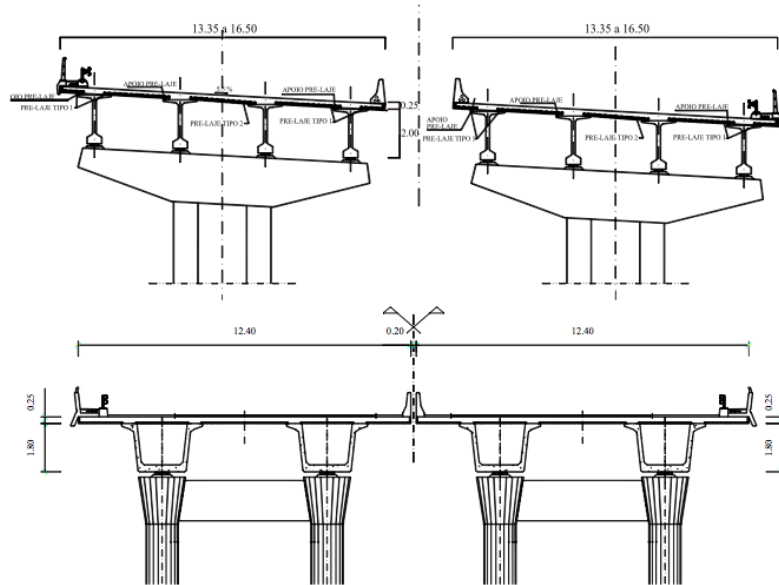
Corte de uma ponte com vigas em I e outra com viga caixão
